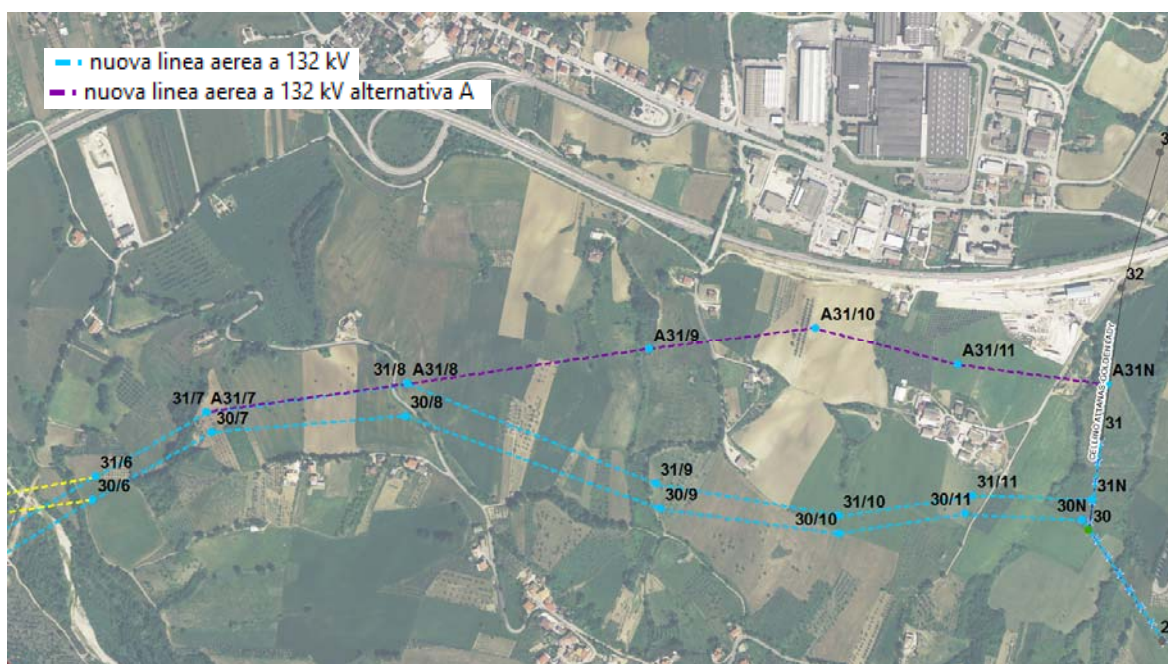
Stralcio progettuale su ortofoto con evidenziata l'alternativa A
